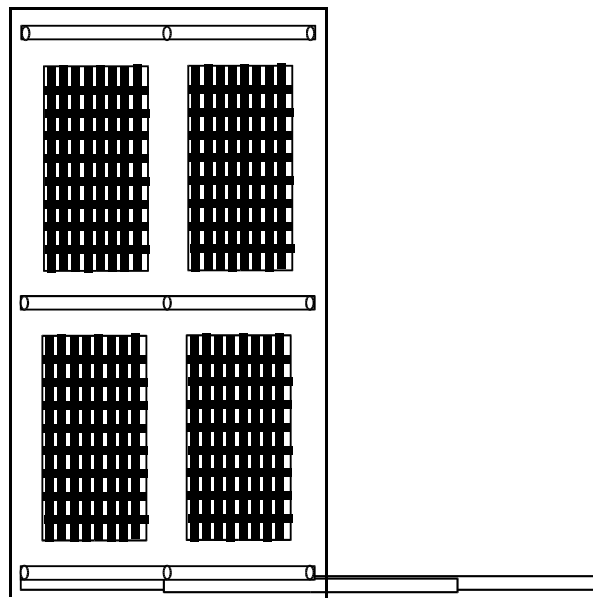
‘Probalho’ sobre lajes nervuradas apoiadas em vigas
